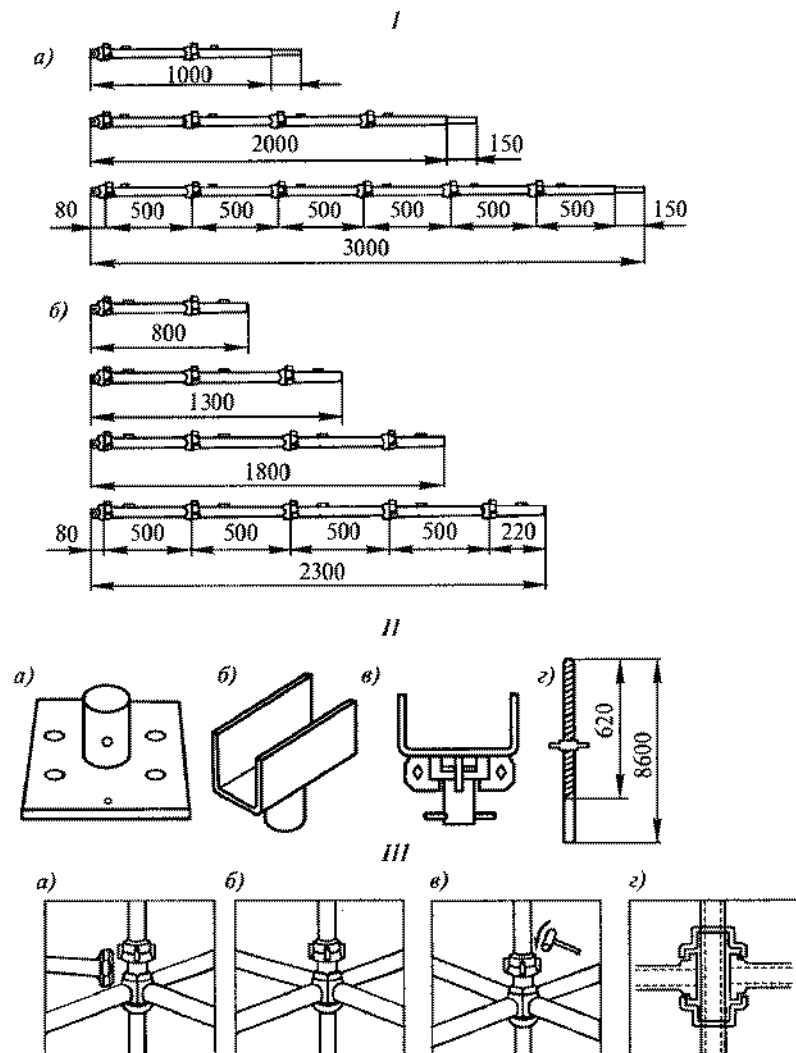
Опалубка перекрытий фирмы «Каплок» — опорные стойки:
